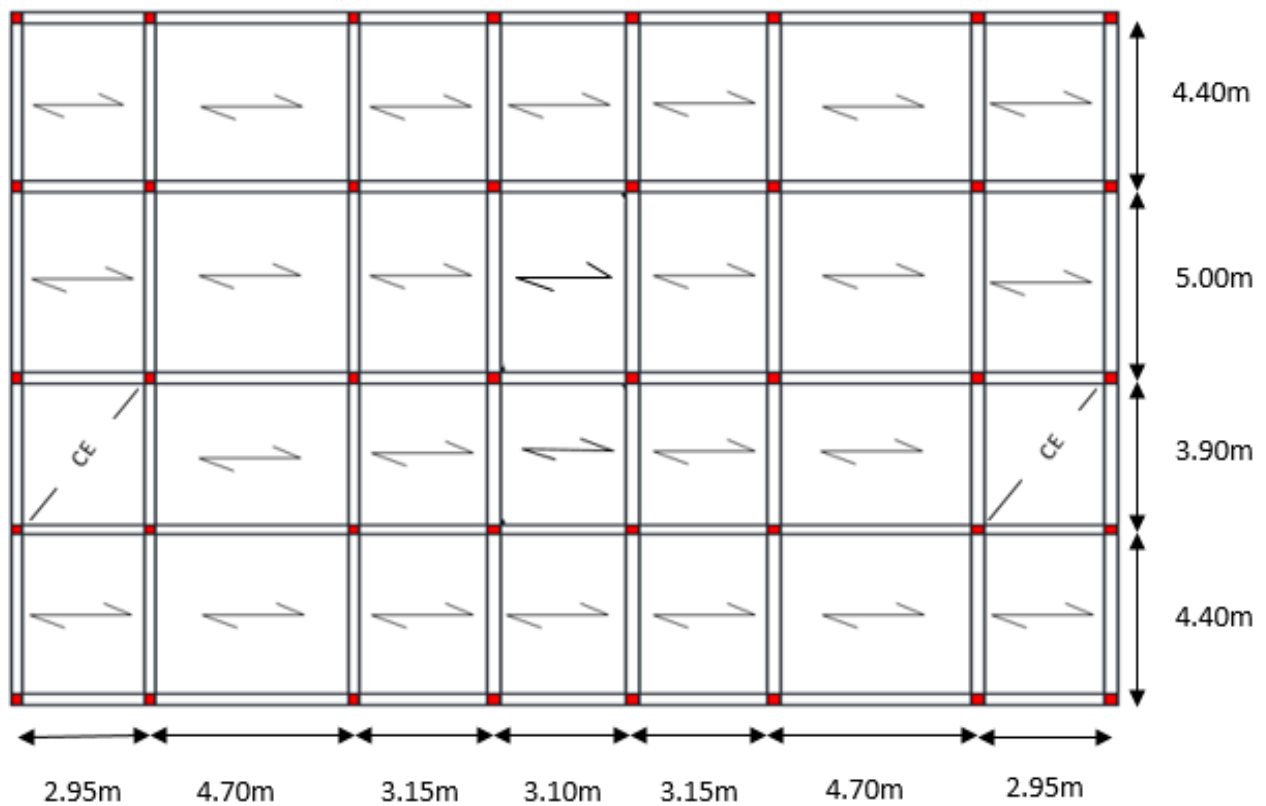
sens disposition des poutrelles pour le sous-sol, RDC, 1^{er} et 2^{eme} étage
